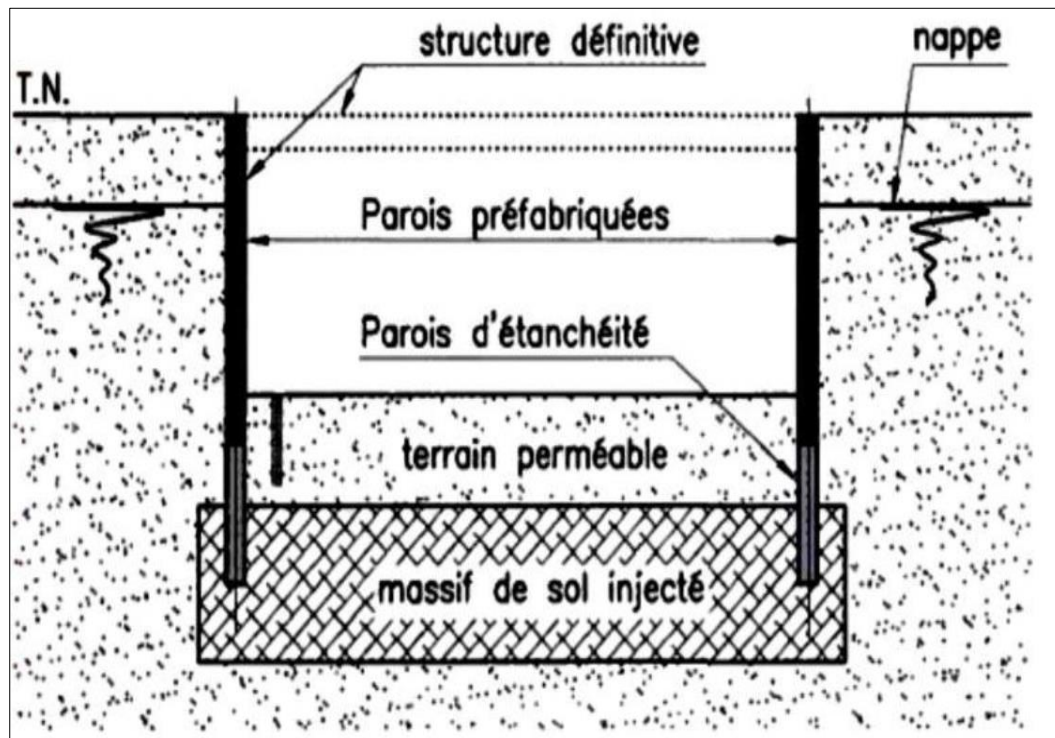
Étanchement du fond de fouille par injection du terrain (DWA, 2020).
